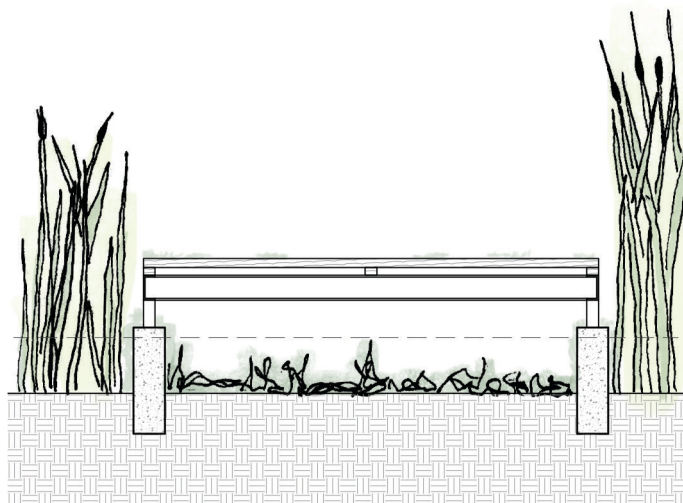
Detalhe palafita em estrutura mista de concreto e aço com piso em régua de madeira
